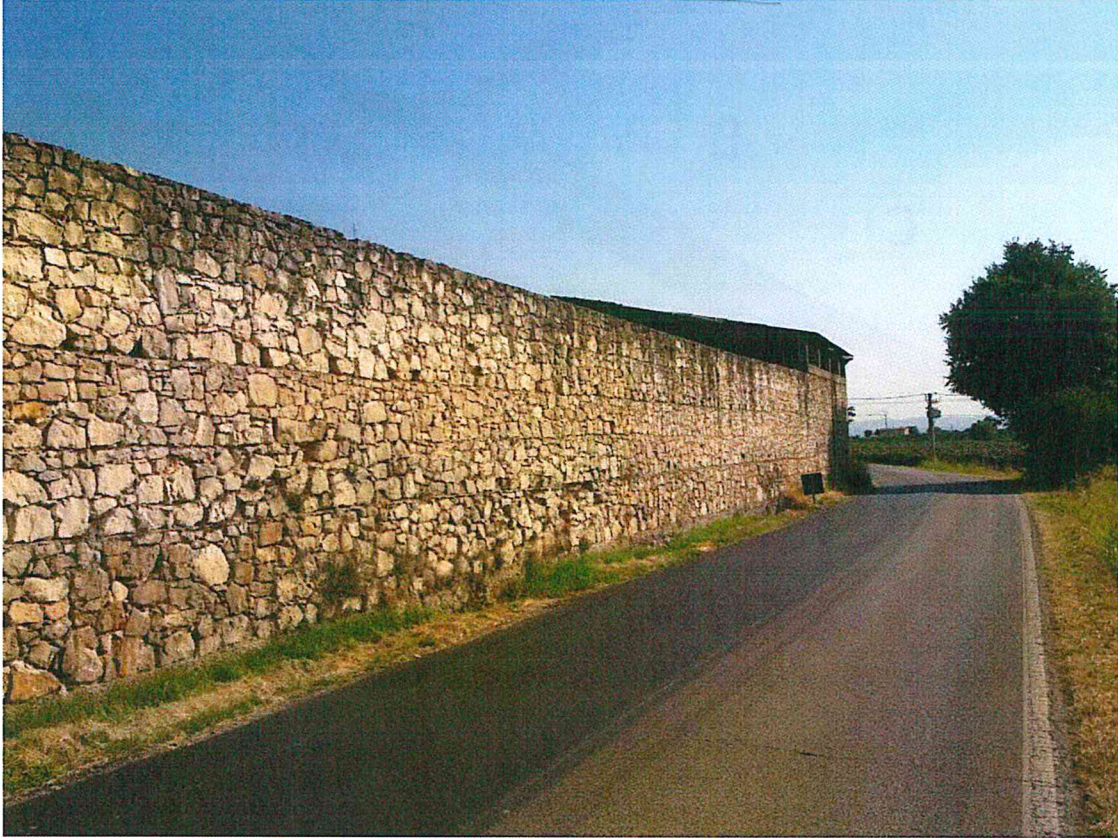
Vista del recinto in sasso sbazzato dalla strada che conduce verso Sommacampagna. In evidenza nella parte più estrema verso destra del muro uno dei fabbricati costruiti in adiacenza e sopra al muro in sasso sbazzato.
